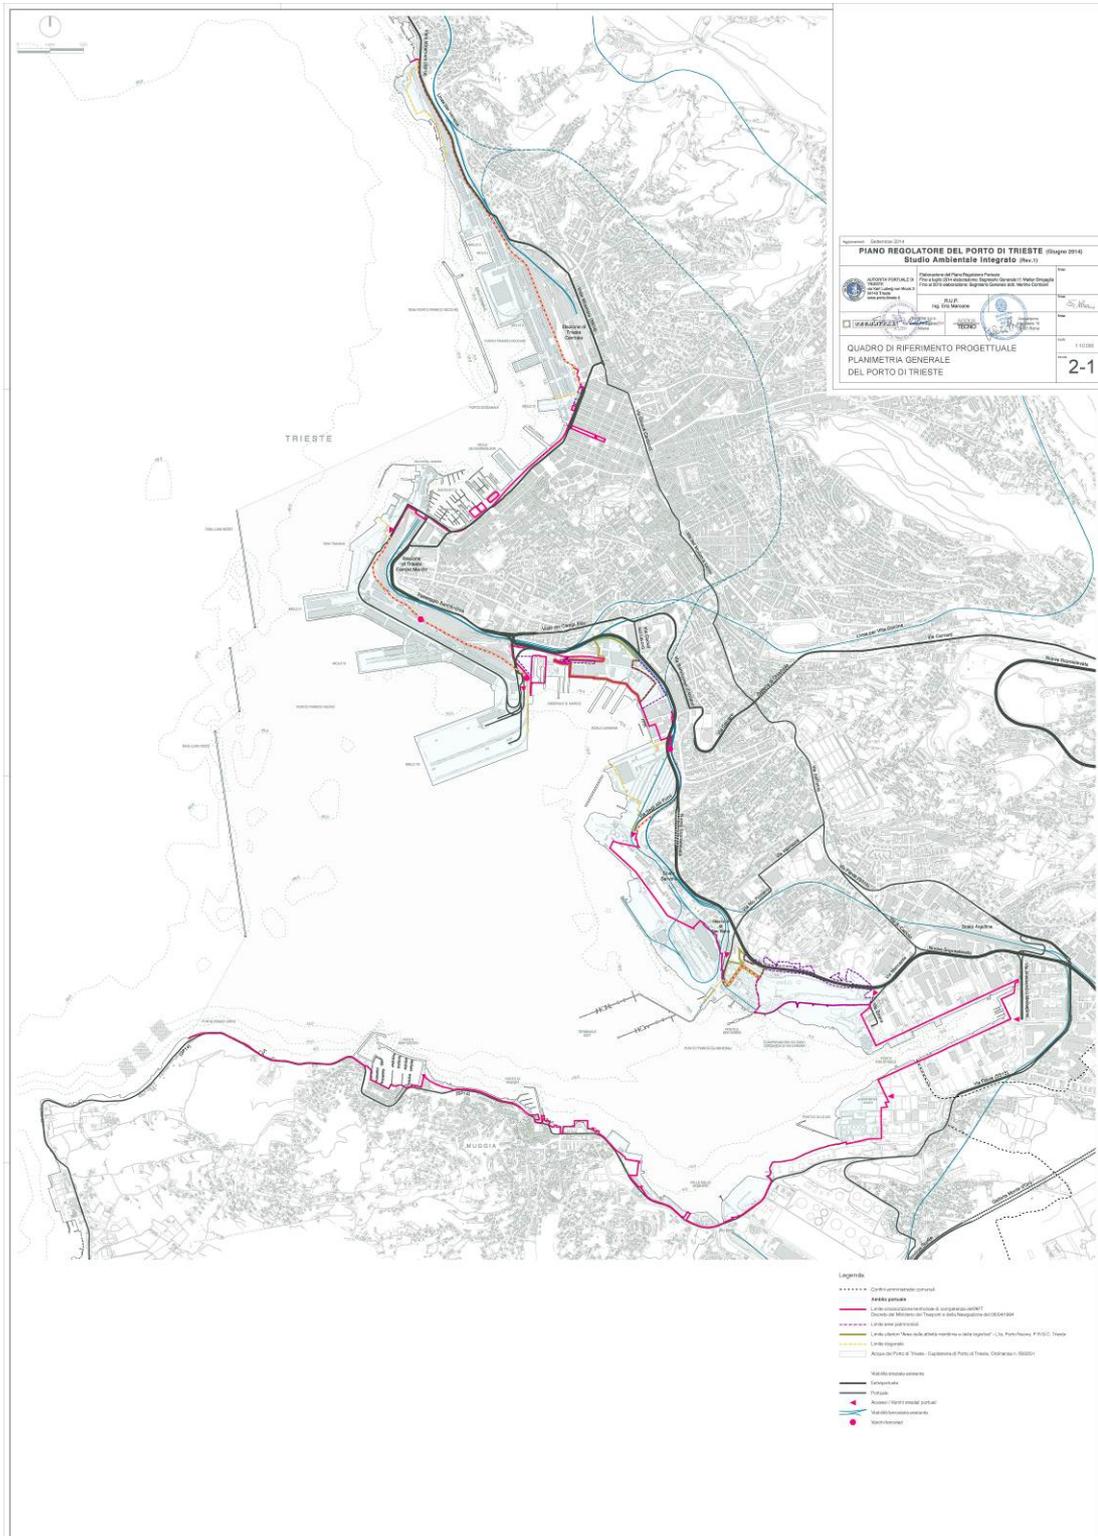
PLANIMETRIA GENERALE DEL PORTO DI TRIESTE
